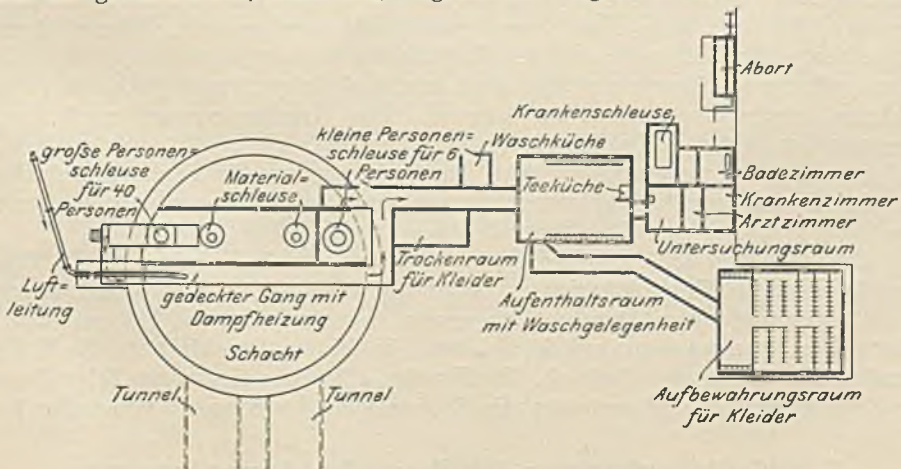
Anordnung der Aufenthaltsräume usw. beim Bau des Hamburger Elbetunnels.
